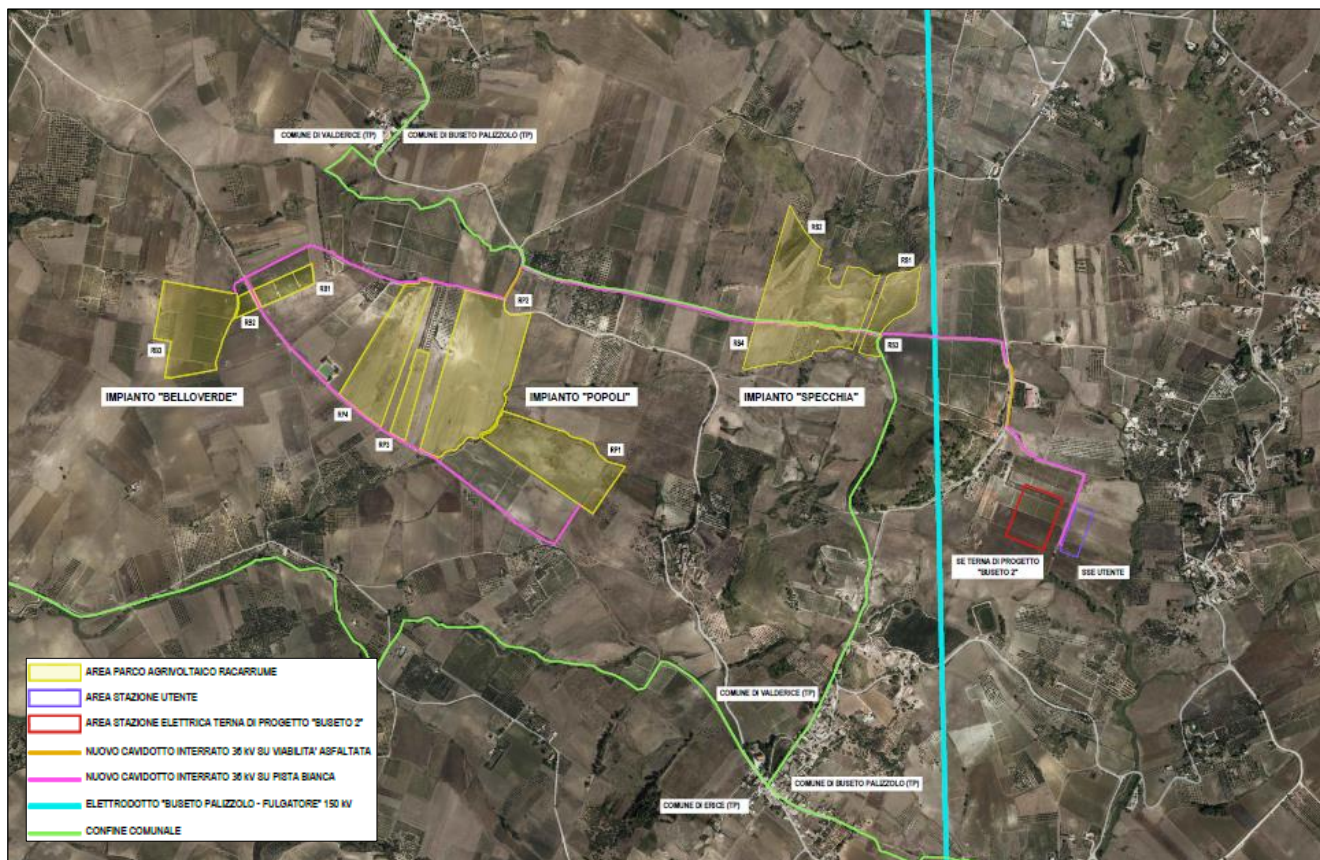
Inquadramento opere in progetto su Ortofoto (Scala 1:10000)
